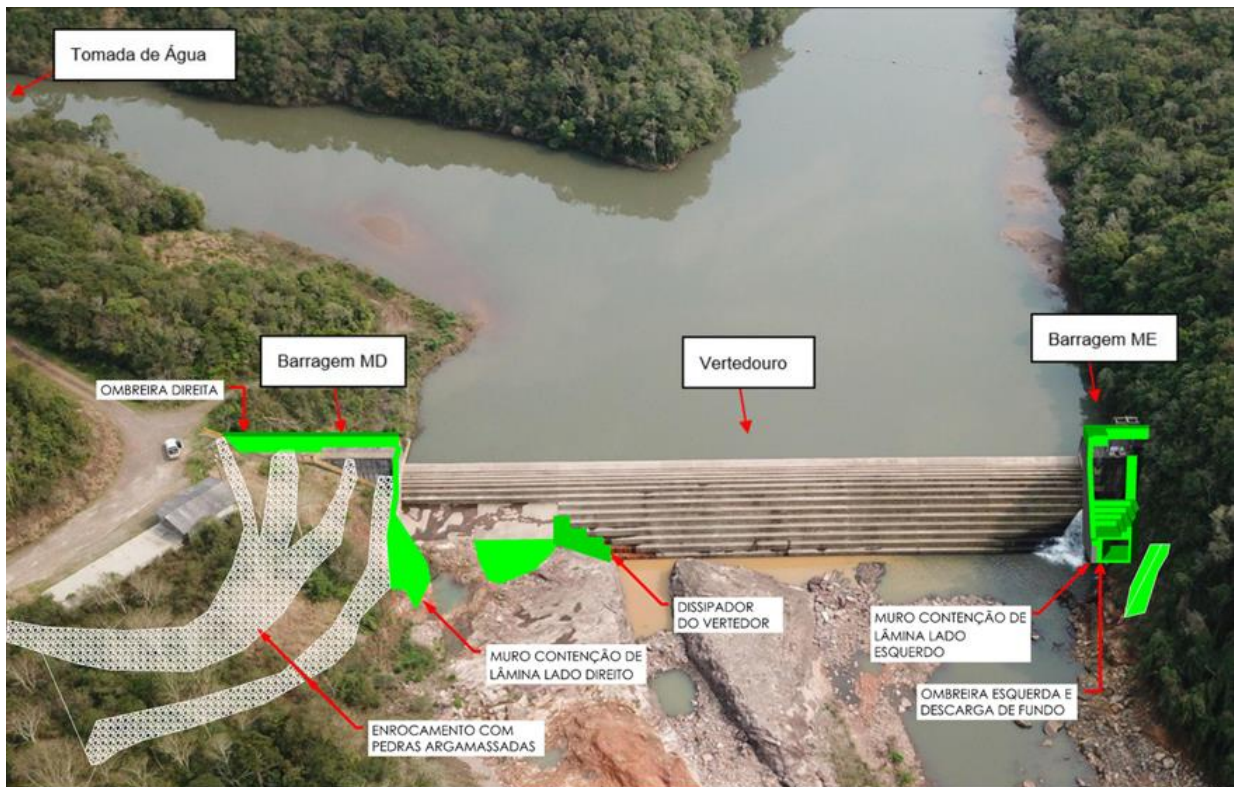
Vista Geral da Barragem com Reforços Estruturais Indicados
